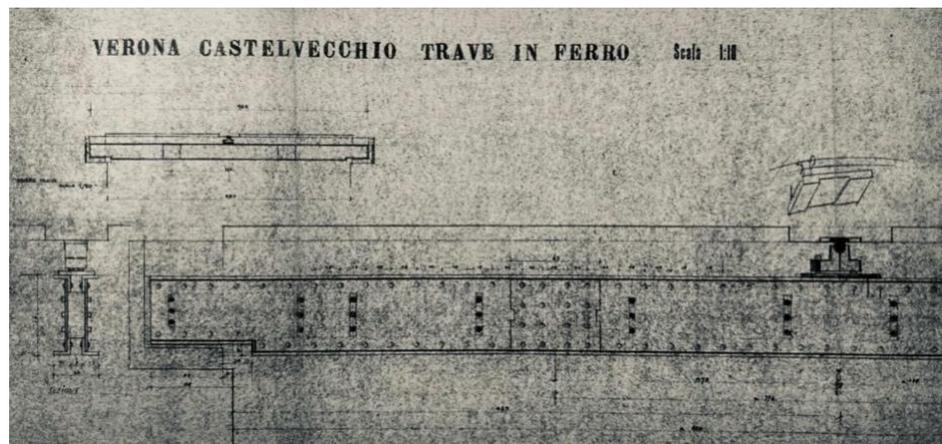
Detalhamento da viga metálica com a peça da junta que une o forro em concreto
